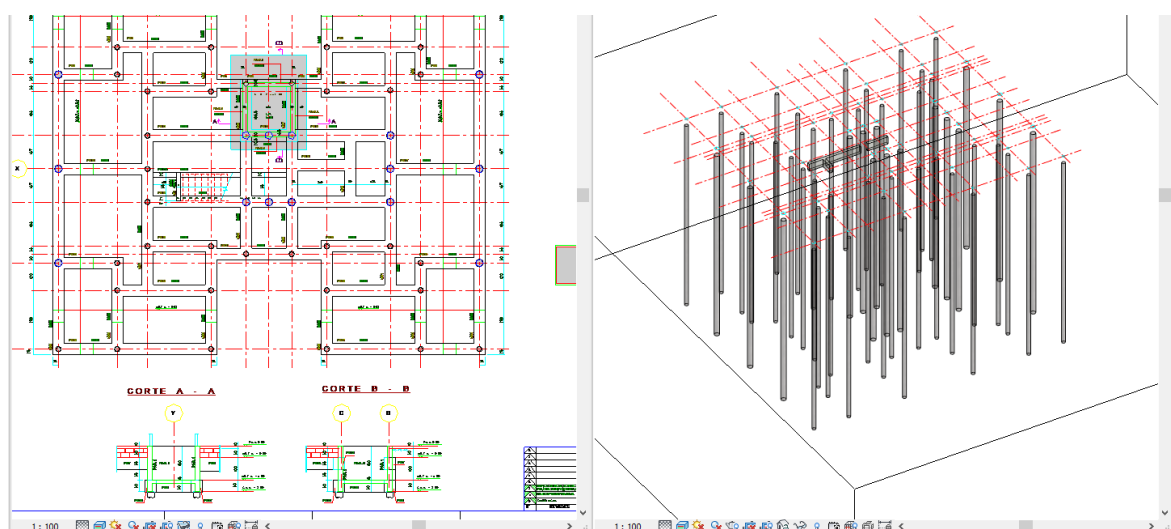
Modelagem de estacas-hélice em planta e acompanhamento tridimensional.
